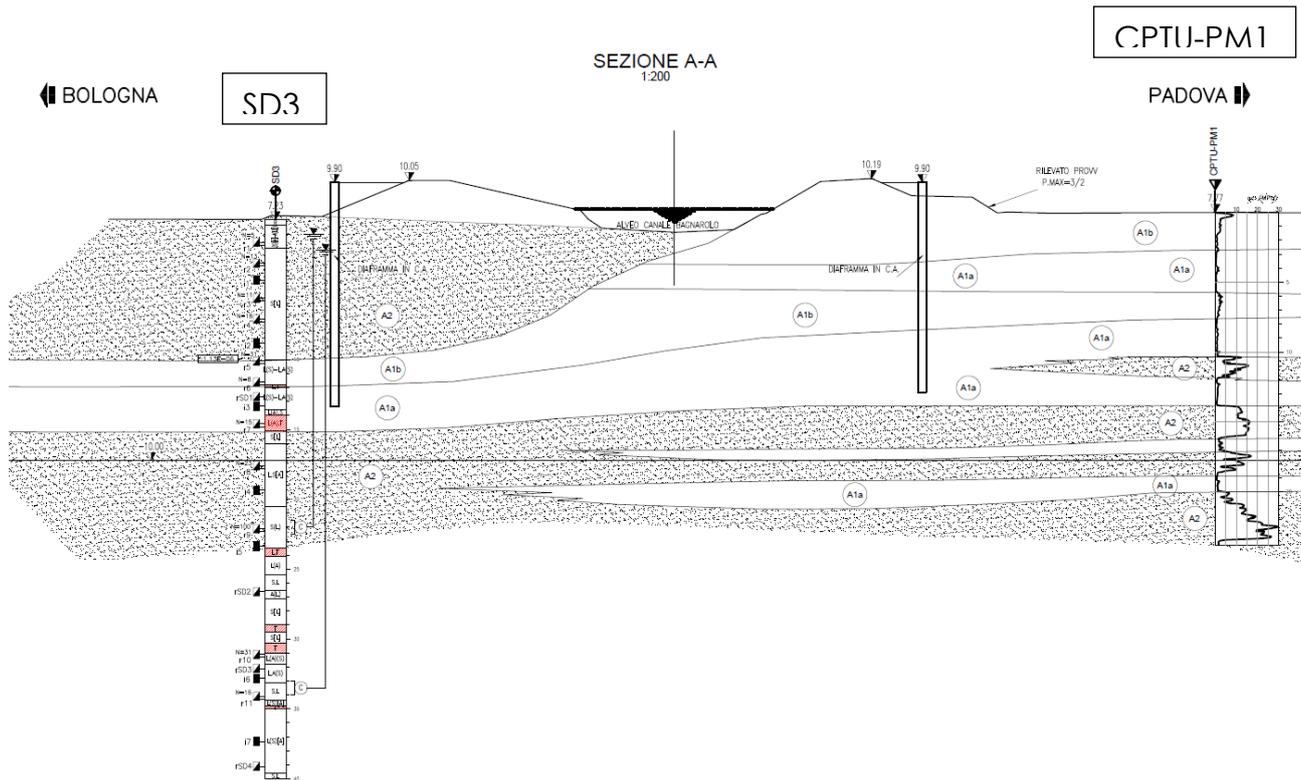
Ponte Canale Bagnarolo - Sezione geotecnica A-A
